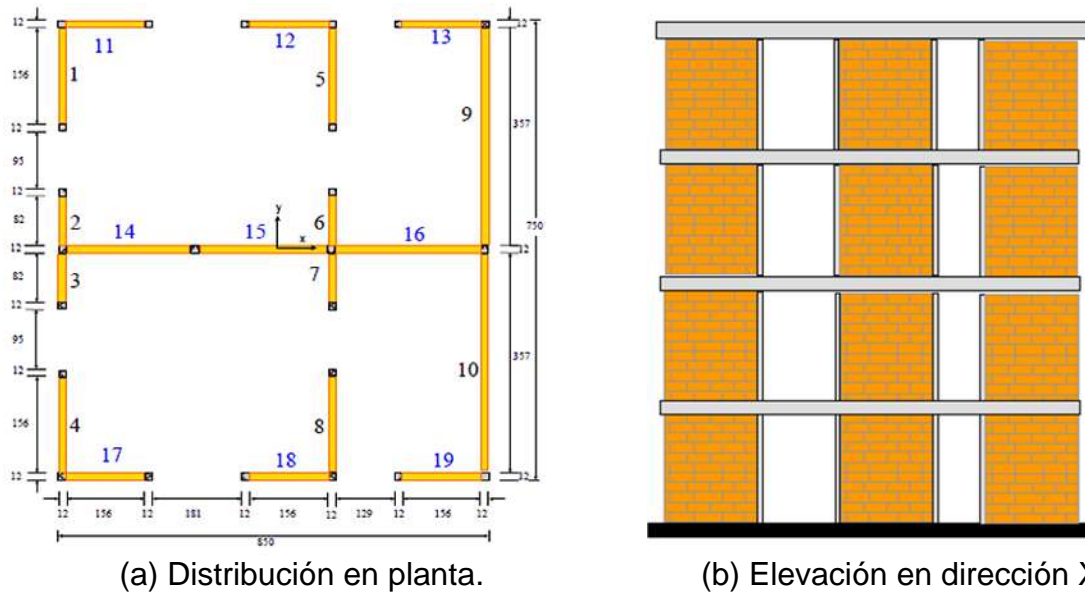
Planta y elevación de estructura de mampostería confinada.
